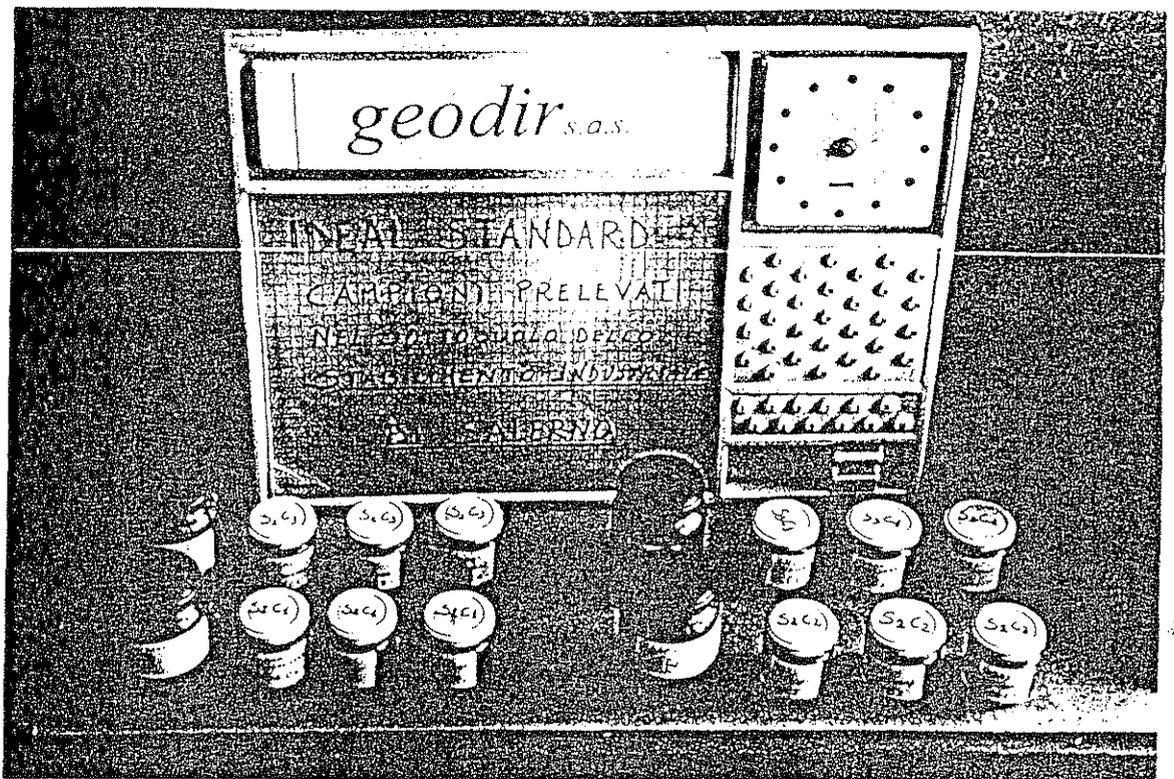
campioni di terreno prelevati nei sondaggi S2 ed S3 e distinti dalle sigle: S2 C1; S2 C2; S2 C3; S3C1
